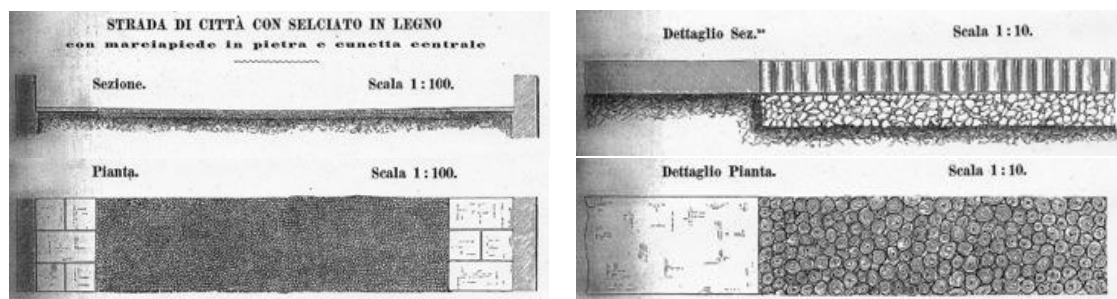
> Modelo de calle con pavimento de madera y acera de piedra (escala 1:100 y 1:10) otro modelo que utiliza la madera para pavimentar tanto la calzada como la acera (En AMCB 1889-90)
